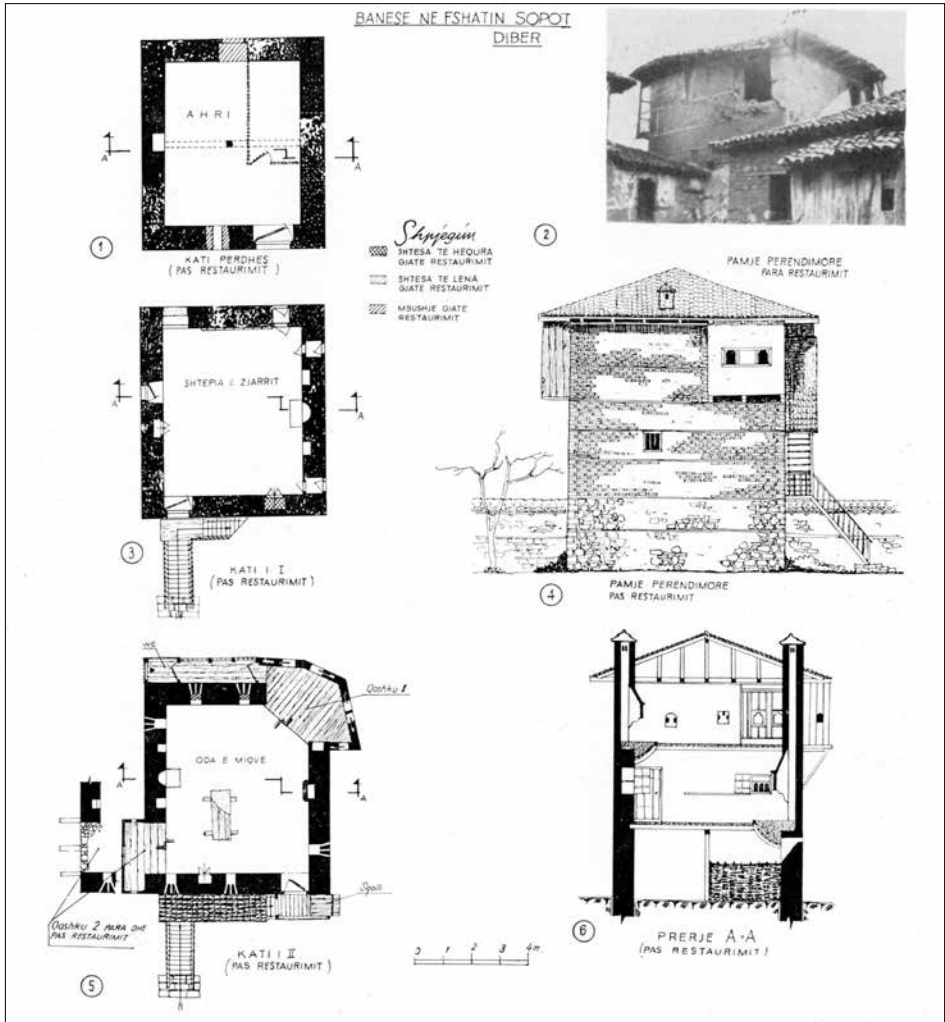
Il progetto di restauro di una abitazione tradizionale a Sopot, piante, prospetto e sezione. Leonard Suli, *Monumentet*, 19, 1980
